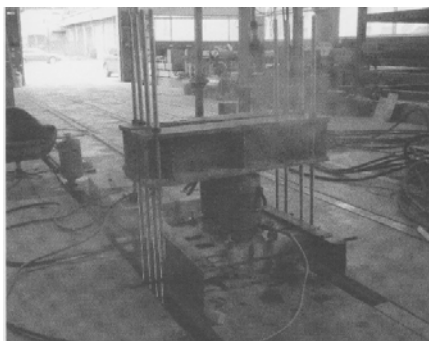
Общий вид опытного образца стыков плит в стенде для испытаний
